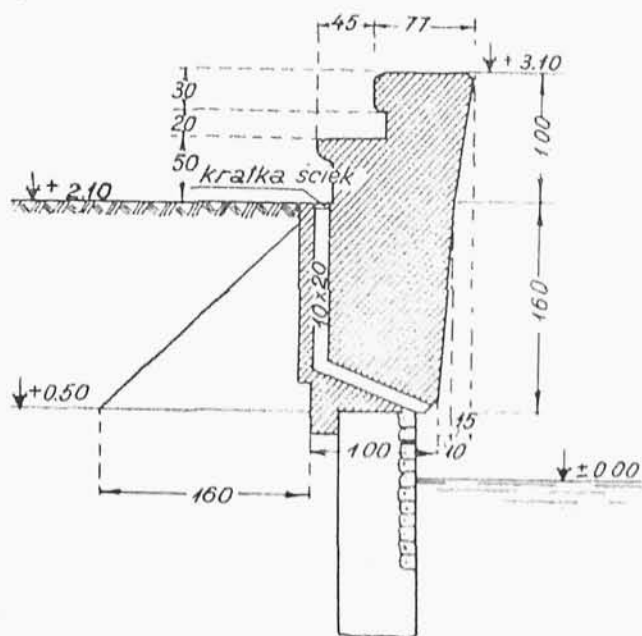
Przekrój nabrzeża na skrzyniach żelbetowych
